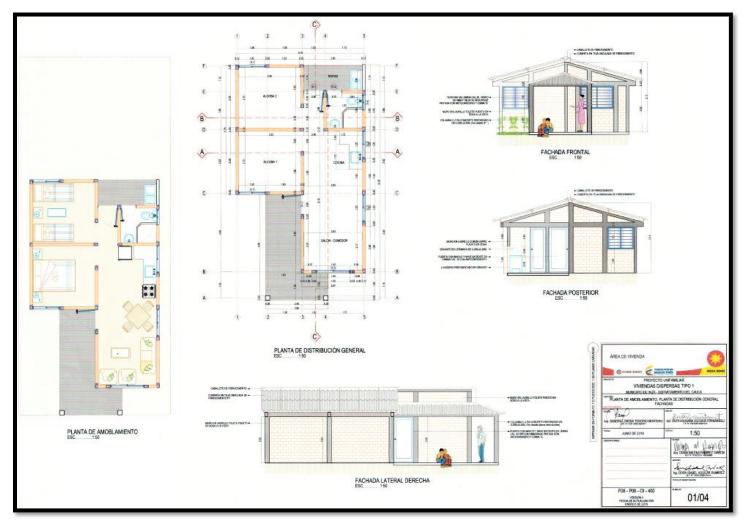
Plano arquitectonico, planta de amoblamiento, distribucion y fachadas de la vivienda tipo 1.
